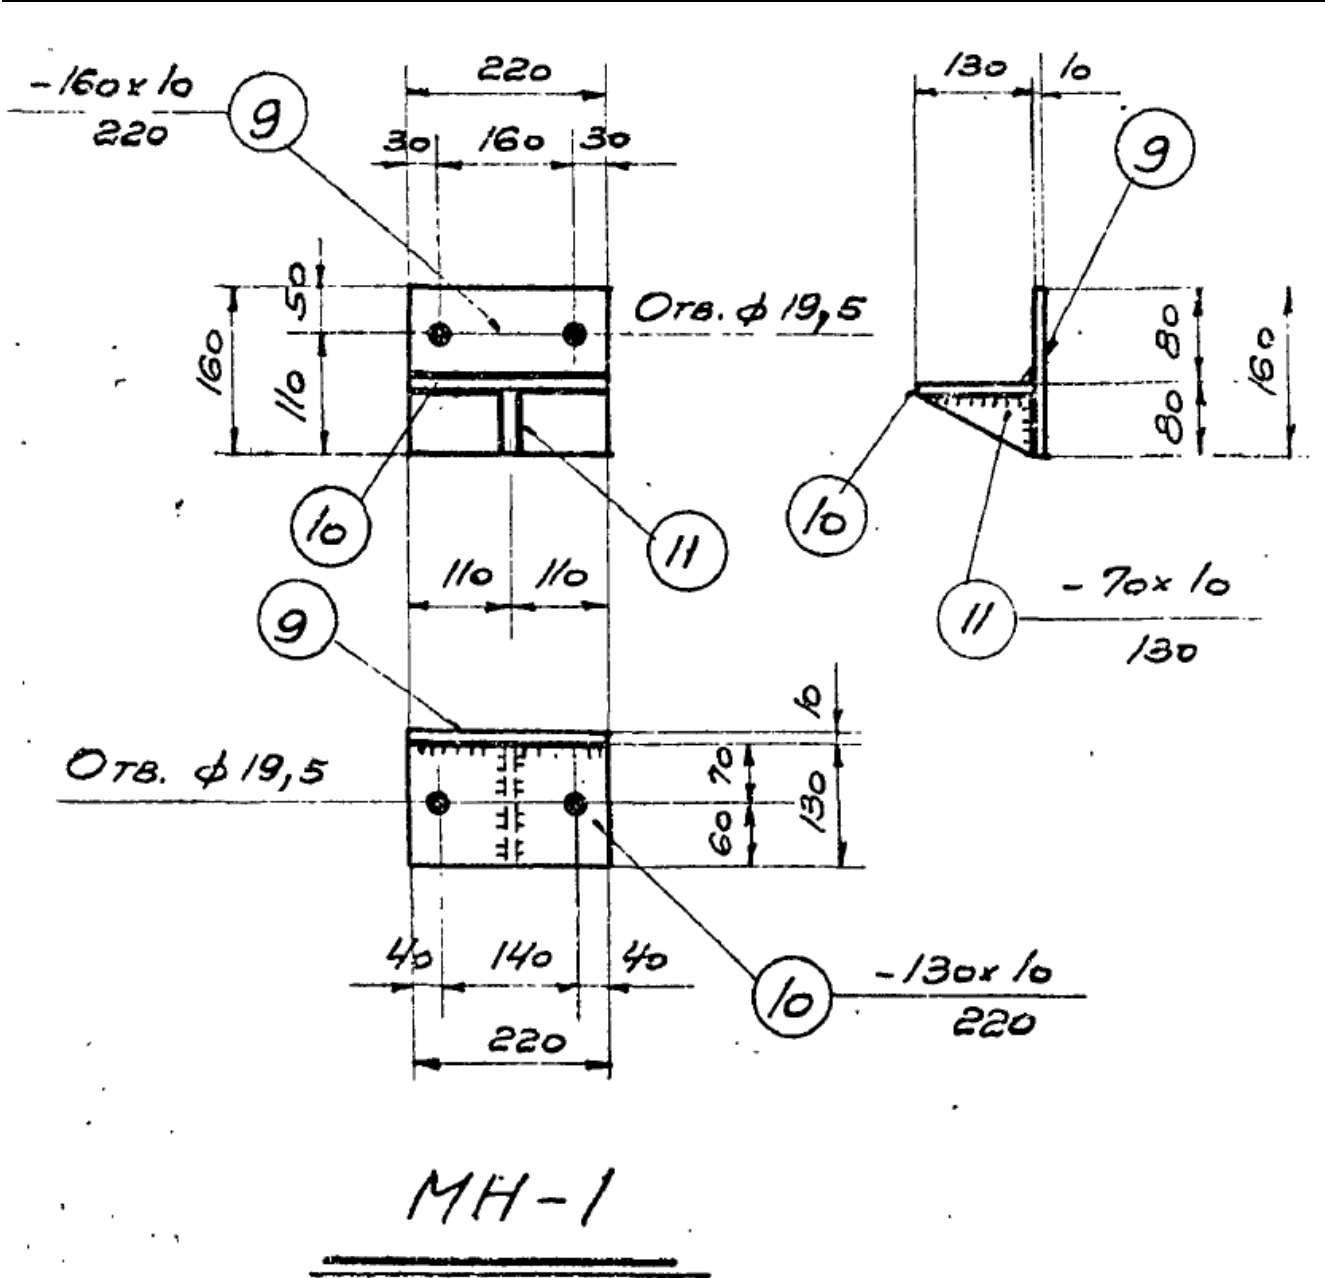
Детализовочный чертёж существующей закладной детали в ферме ФС-2
